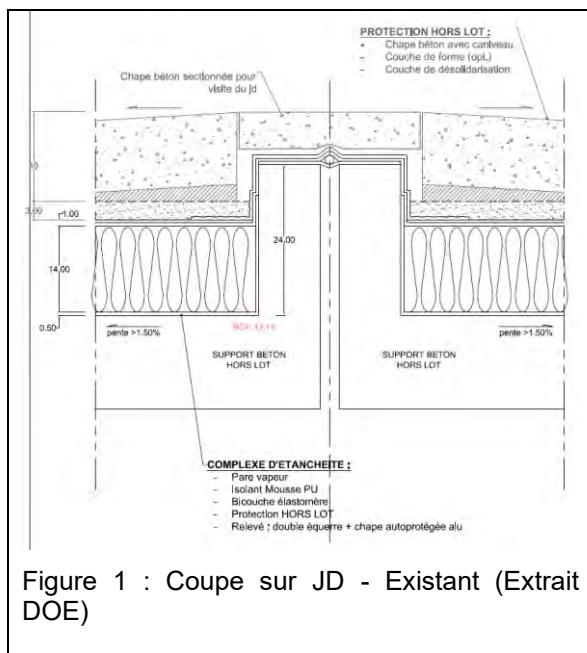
Coupe sur JD - Existant (Extrait DOE)
